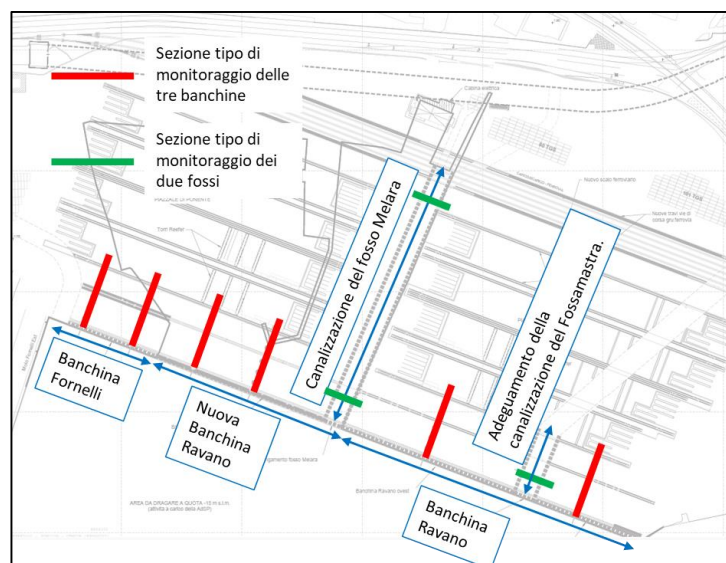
Planimetria con indicazione delle sezioni di monitoraggio strutturale
